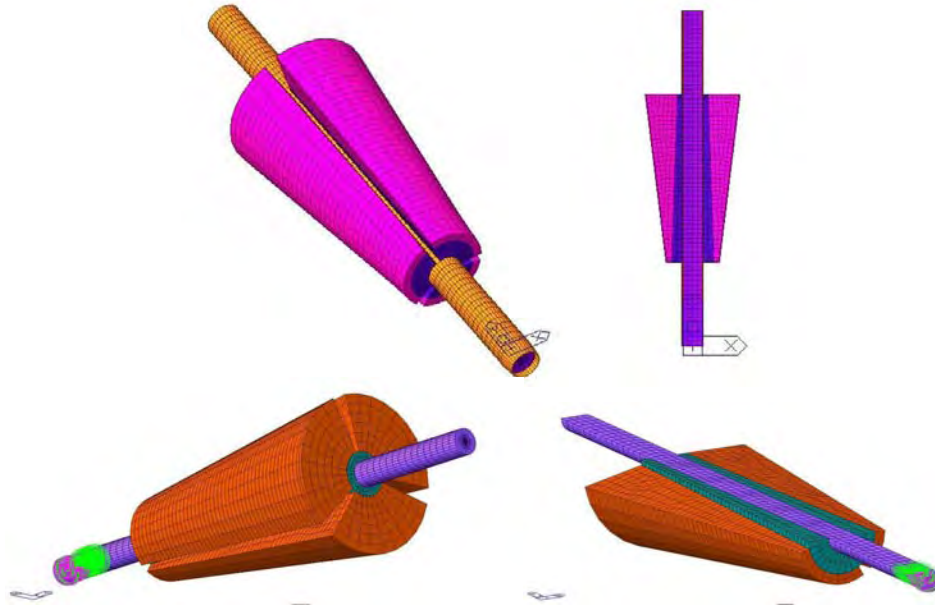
Vistas generales del anclaje modelado y corte de anclaje base
